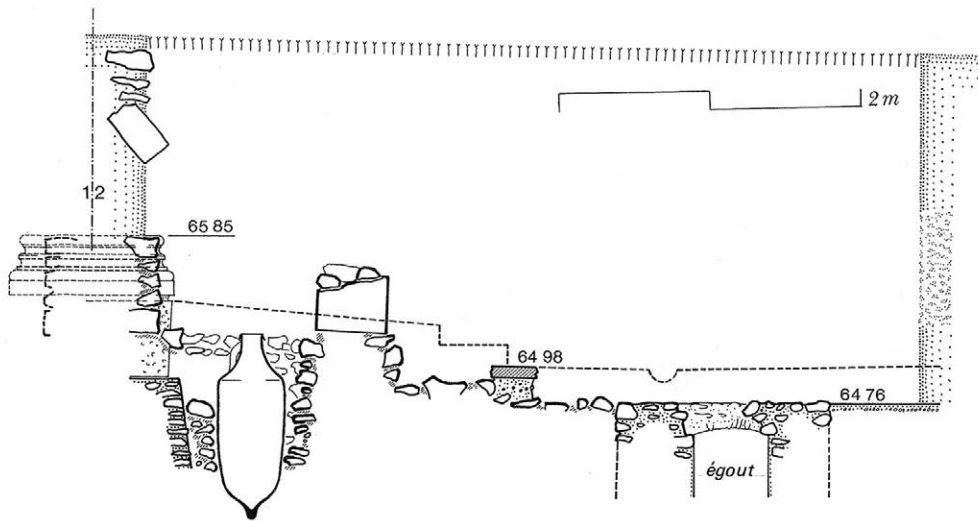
Coupe en avant du portique sud et à l'est de la base 12 (G. Hallier).
